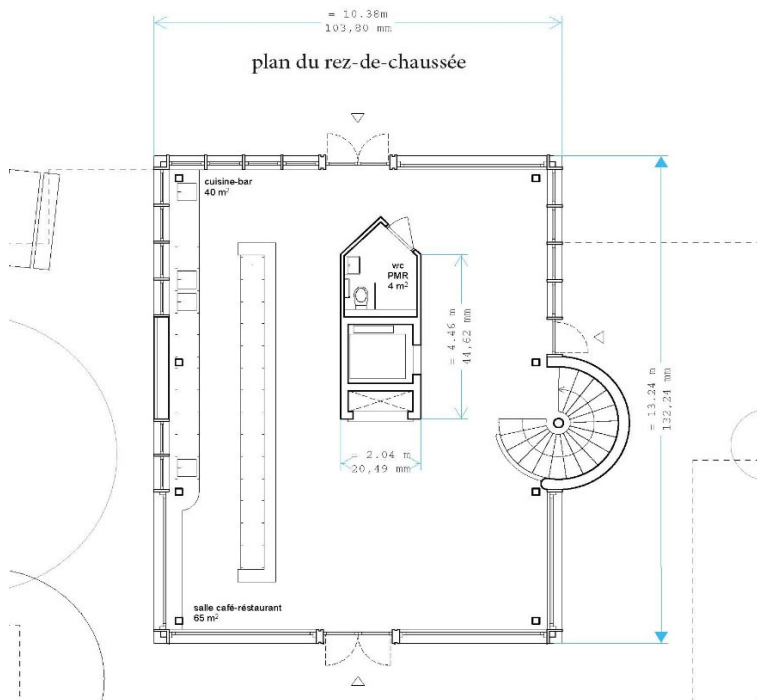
Cotation du plan du rez au 1/100<sup>ème</sup> au format A1, les millimètres (mm) représentés en plan avec leur correspondance en mètre (m), image sans échelle.
